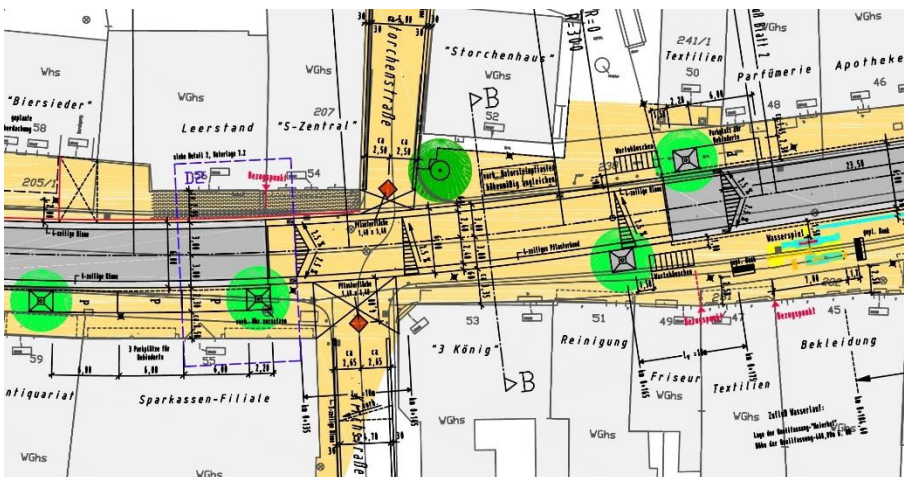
| Zentraler Abschnitt mit besonderer Überquerungs- und Aufenthaltsfunktion: durchgehende Pflasterung der Fahrbahn auf Gehwegniveau in einem dem Seitenraum angepassten Material (die im Plan dargestellten „Wartehäuschen“ wurden nicht realisiert)
